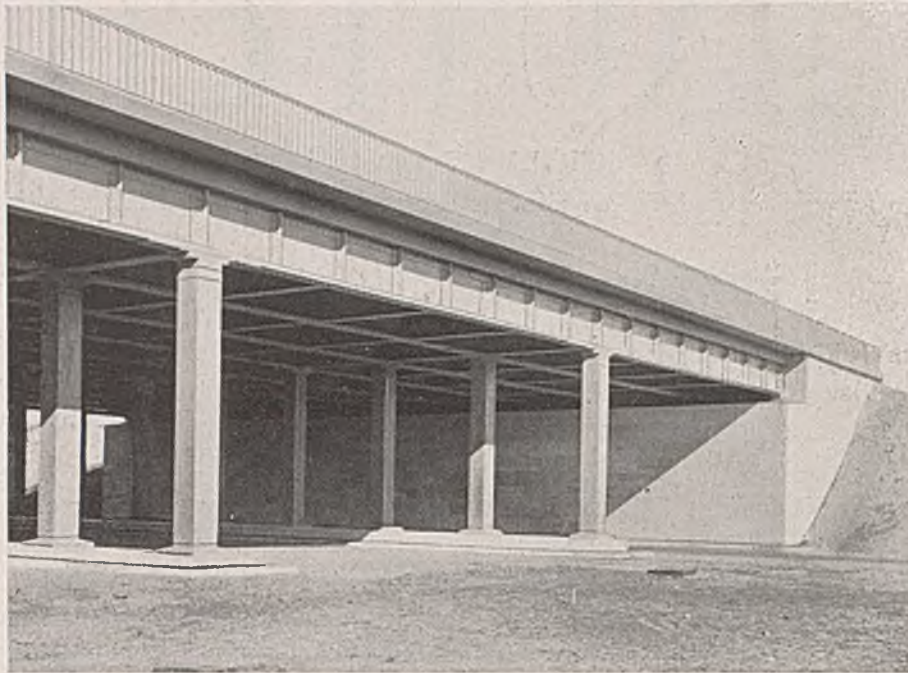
Straßenunterführung am Bahnhof Langwasser.
